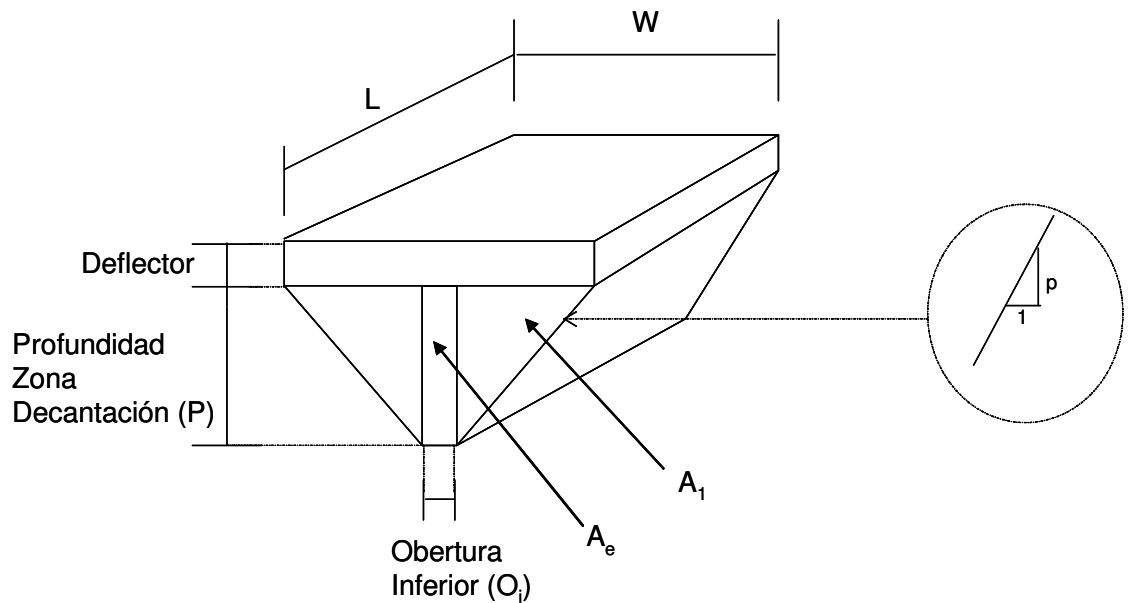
Esquema de la zona de decantación de un tanque Imhoff rectangular.
